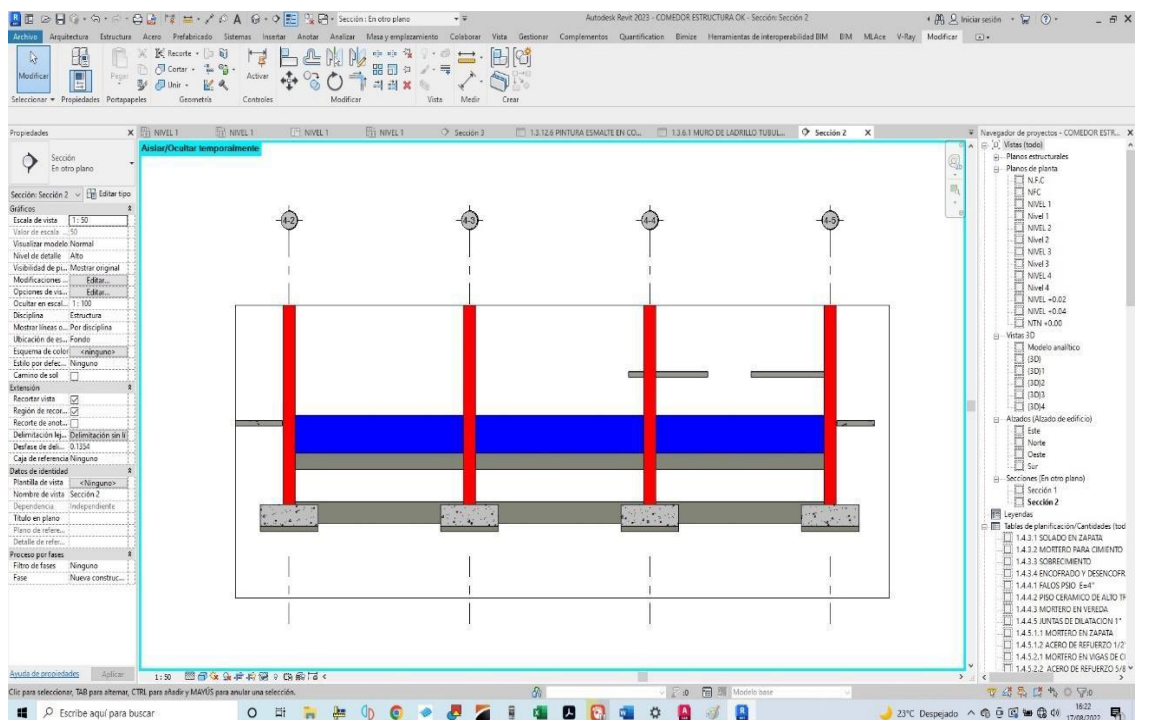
Elevación frontal, vista de zapatas conectadas, vigas de cimentación y sobrecimiento armado.
